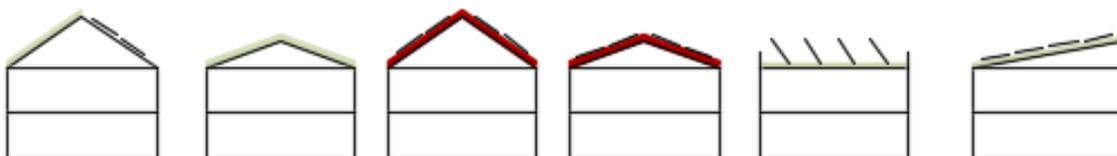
Gebäudetypen WA 1a und WA 1b
